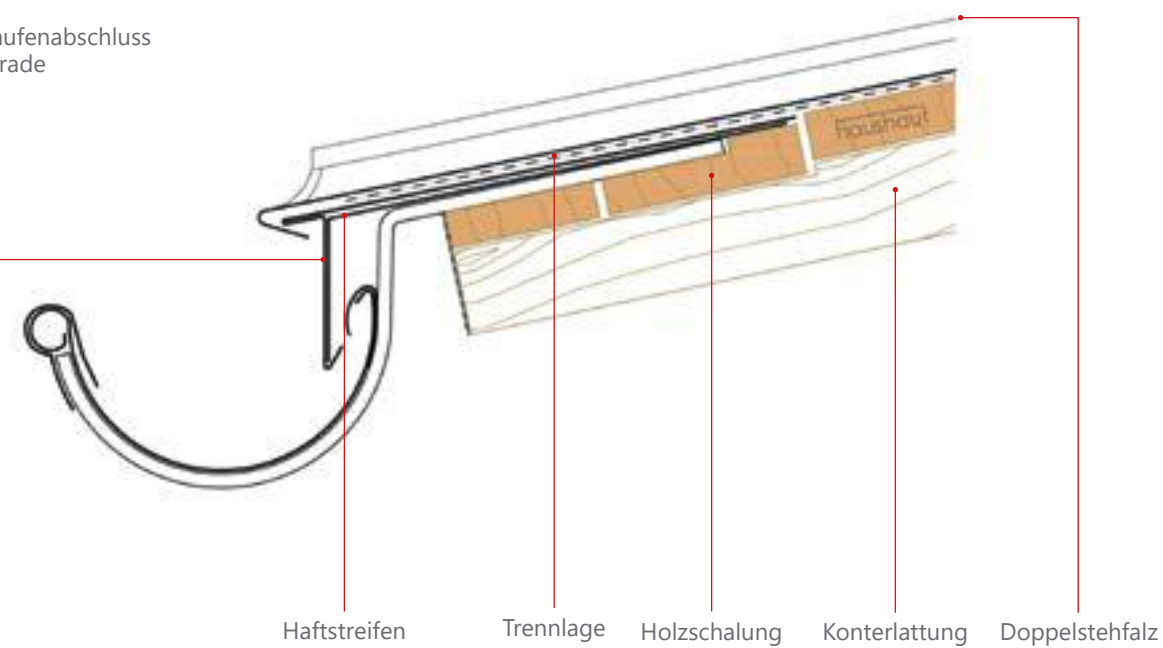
DETAIL TRAUFAUSBILDUNG VARIANTE 1
